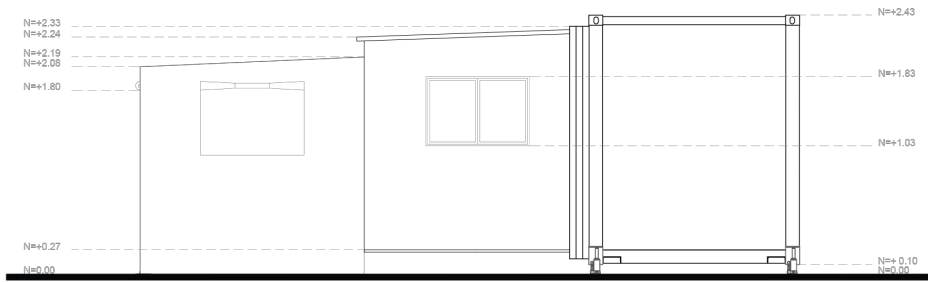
Elevación frontal del habitáculo Emergency Expa Room. Fuente y elaboración: Autores.
